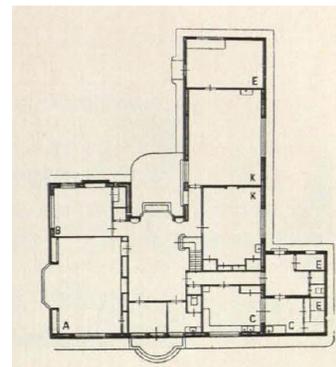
Planta de la Bolsa de la casa "De Maerle", 1906. (Fuente: web "revista arquitectura")
